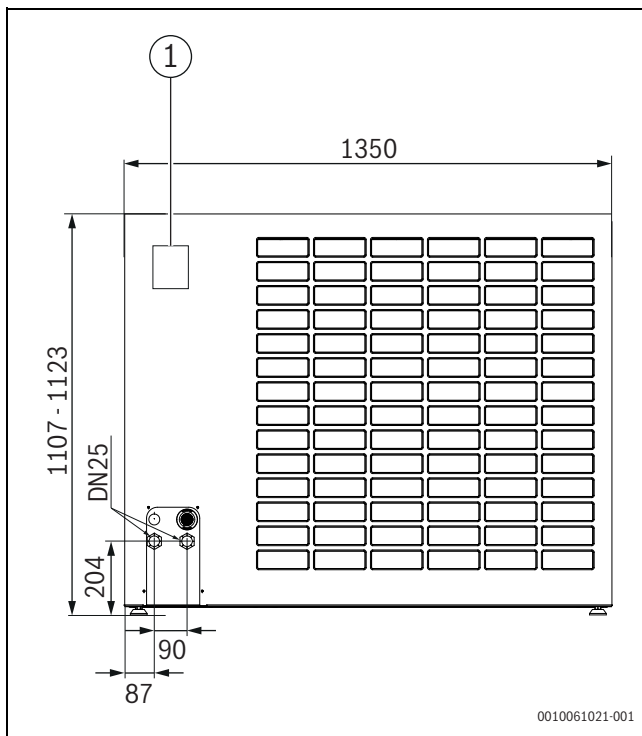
Abmessungen und Anschlüsse der Wärmepumpe, Rückseite
